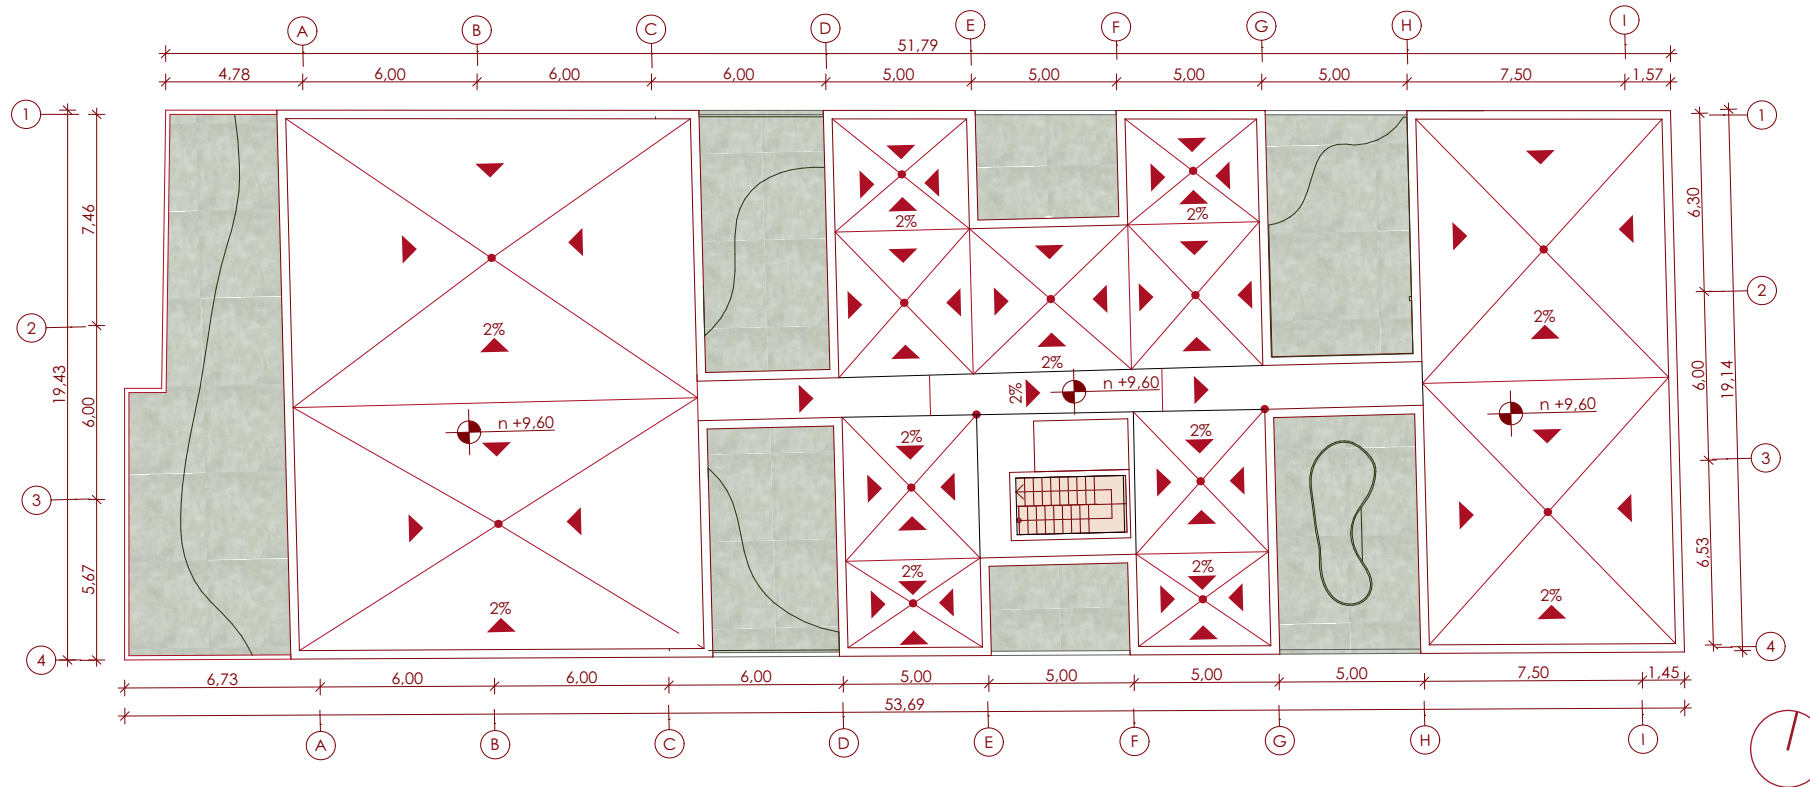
Planta de cubierta del proyecto. Nota. Elaboración propia.
